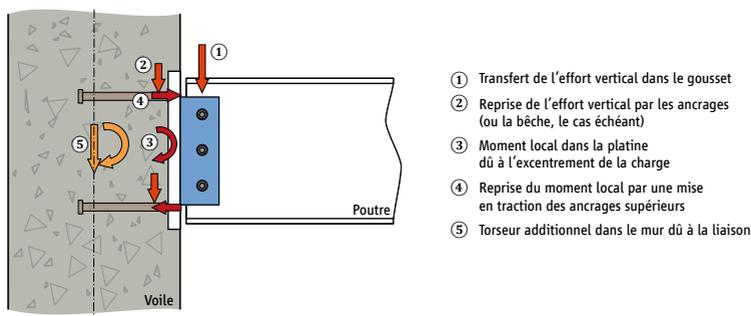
Torseurs et moments additionnels dans le mur pour un assemblage par platine pré-scannée
